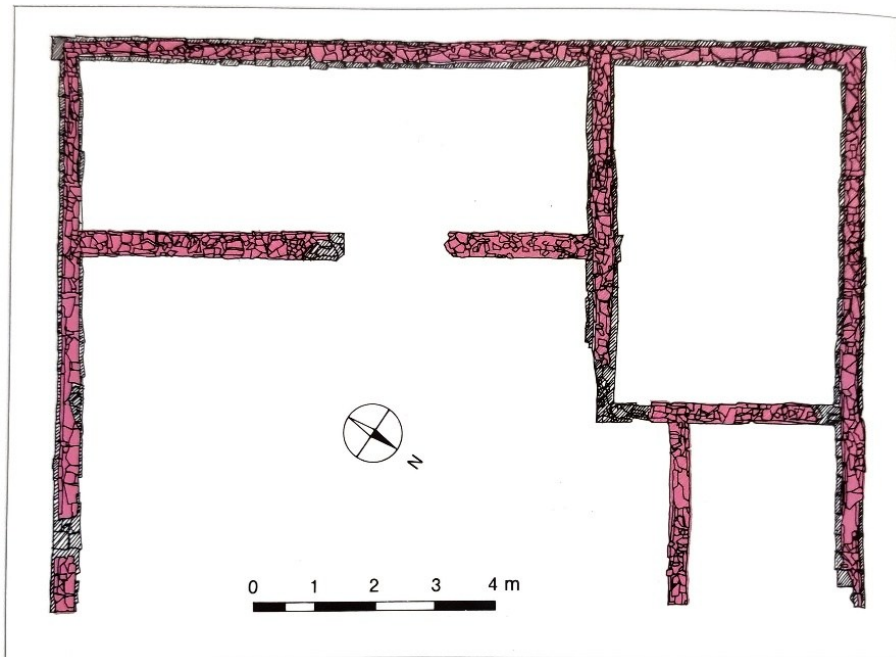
Planimetria dell'edificio E (Uggeri 1989).
